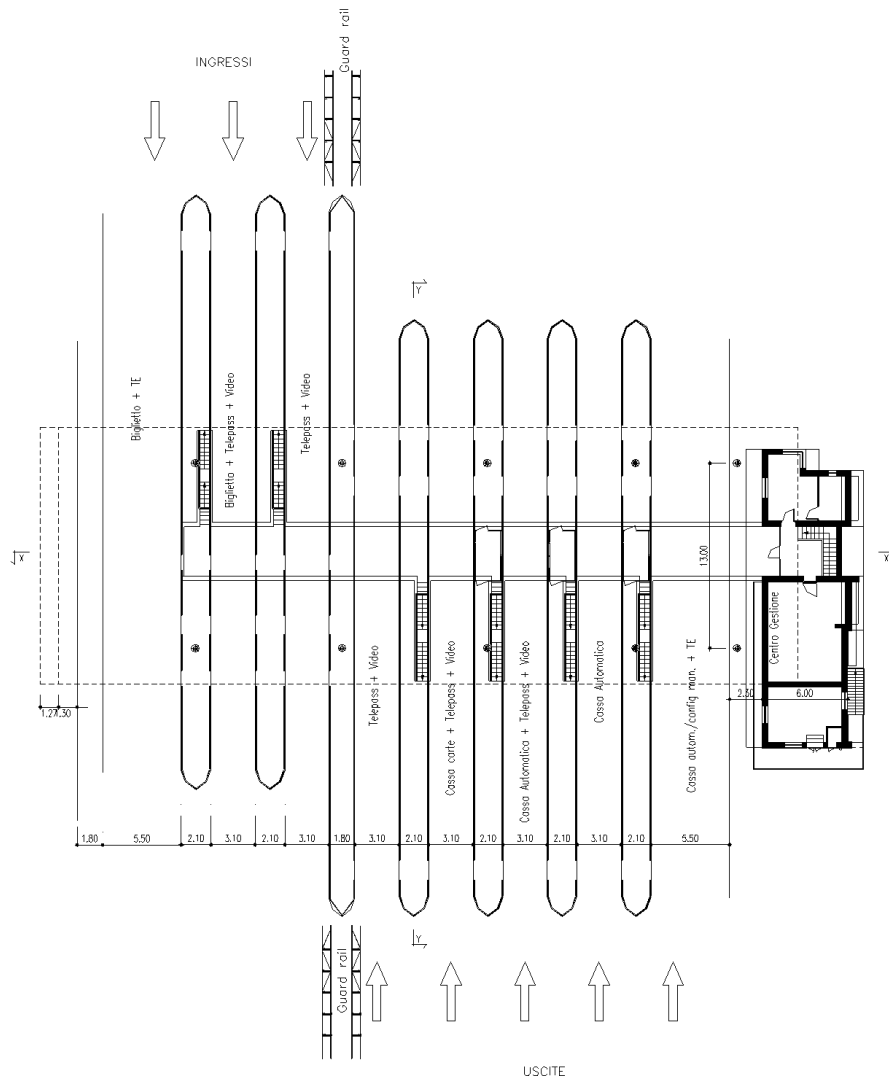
Planimetria Sistemazione Casello ingresso/uscita
